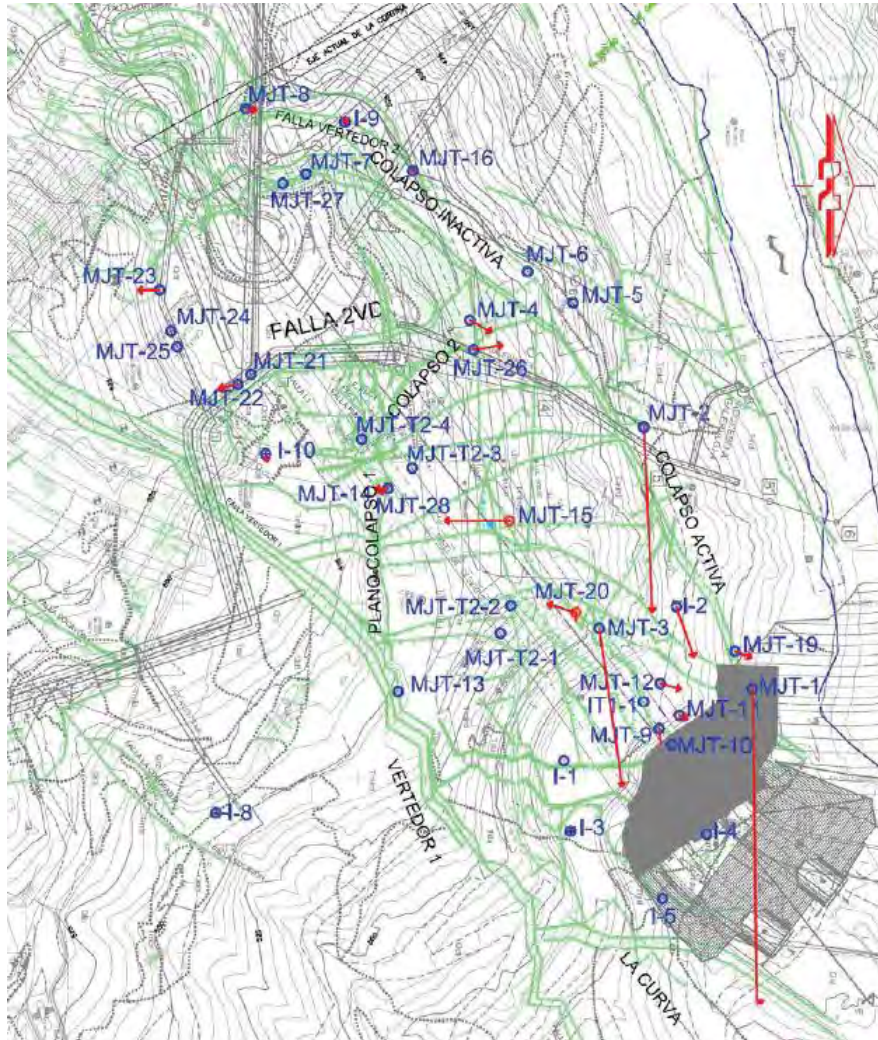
Instrumentación instalada para obtener datos del movimiento de la ladera izquierda en P. H. La Yesca (Inclinómetros, Medidores de junta tridimensional y Extensómetros de barra) (CFE, 2009)
